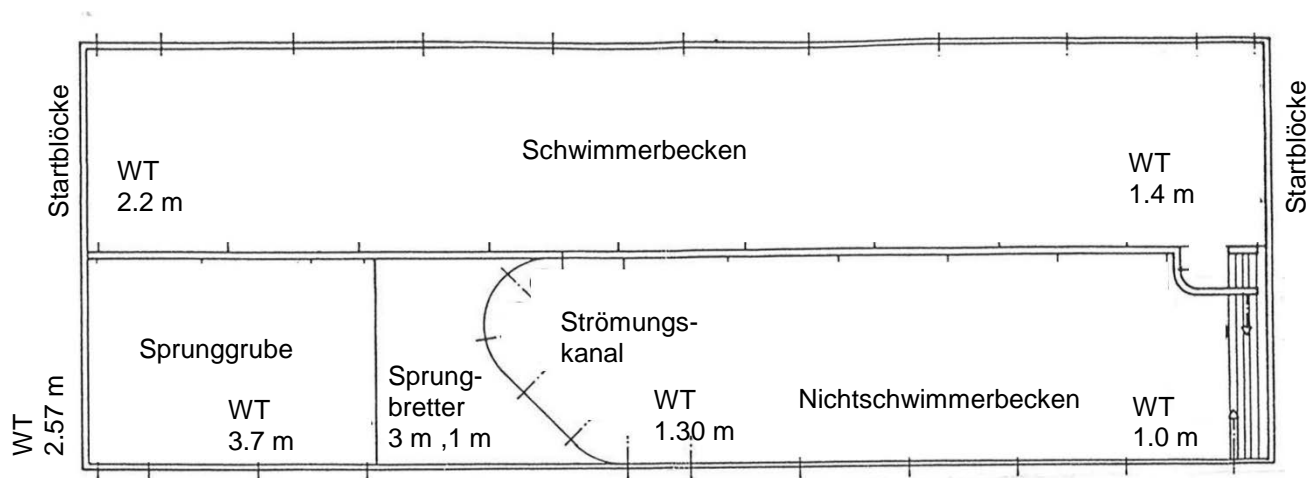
Grundriss Kombibecken mit ergänzten Wassertiefen gemäss Beckenplan
